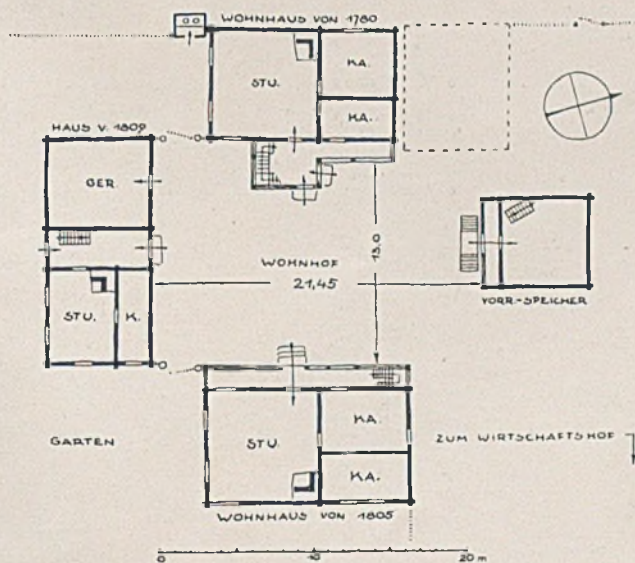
Lageplan mit Erdgeschoßgrundrissen von Hof Harildstad
